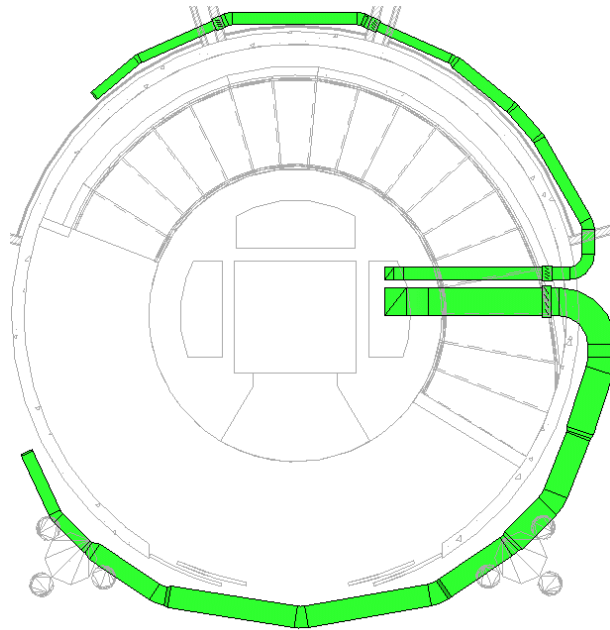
Conductos de extracción de aire del restaurante y los baños (Vistas de planta)
